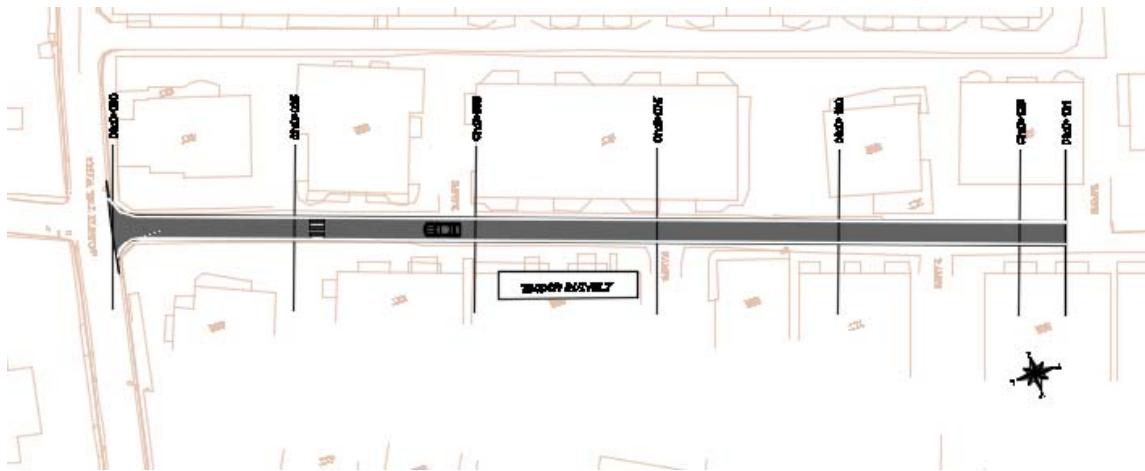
Planimetria e rruges Teodor Rusvelt- Blloku Nr.1
